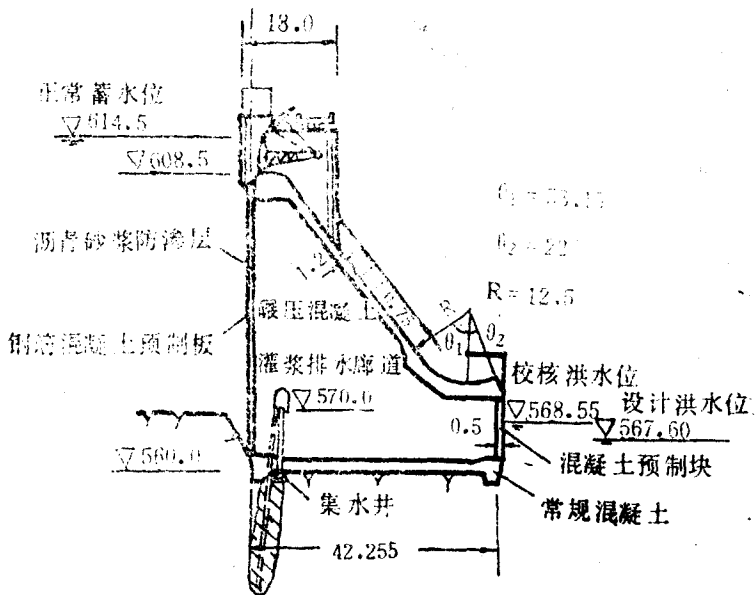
坑口碾压混凝土坝溢流段剖面图 单位米。
